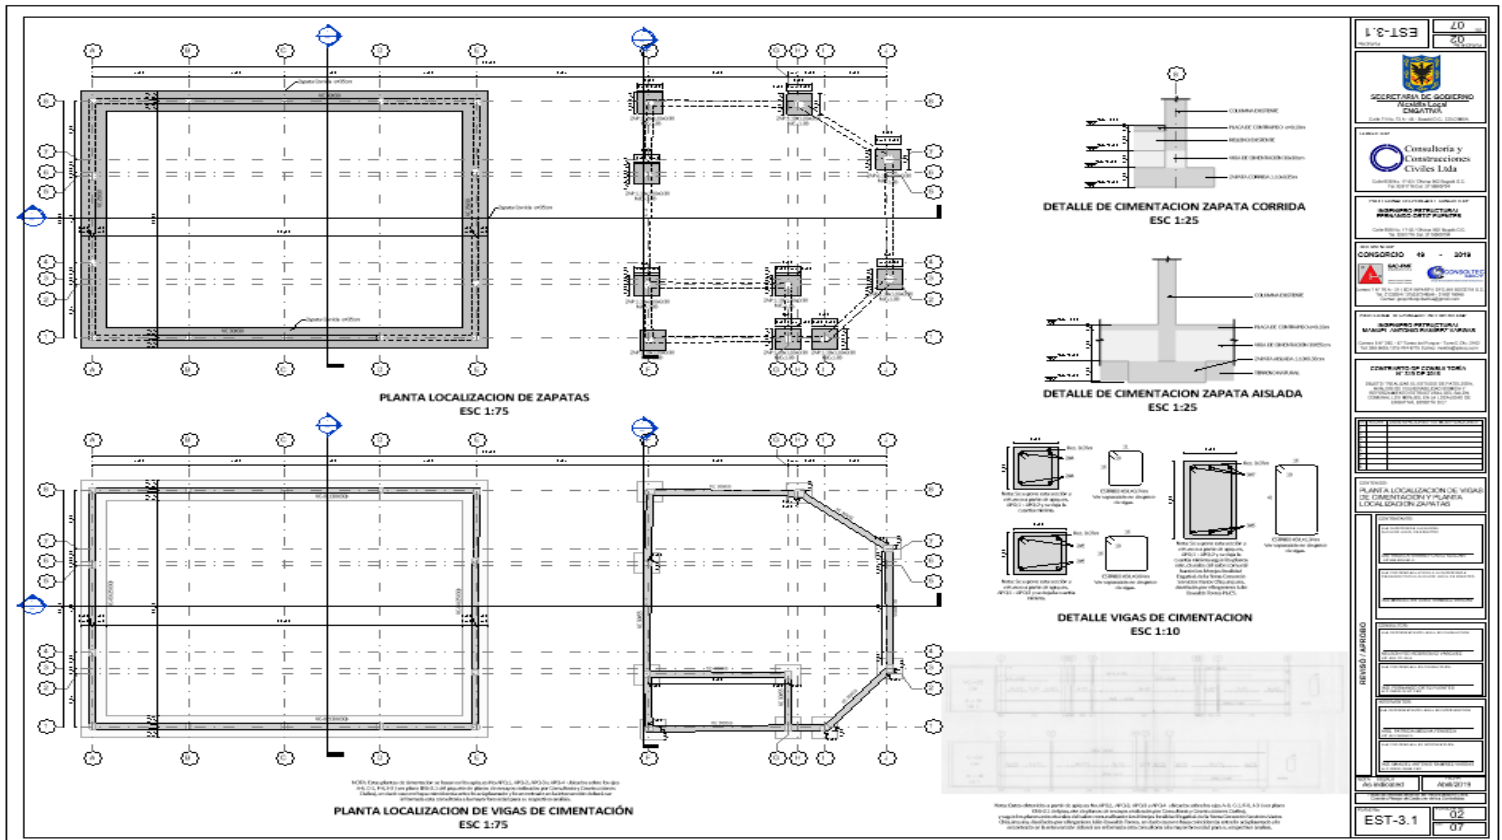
Plano de levantamiento estructural de cimentación. Fuente: Consultoría y Construcciones Civiles SAS.
